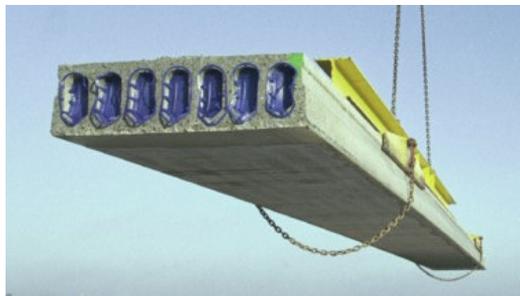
Spannbeton-Hohldecke<sup>147</sup>
